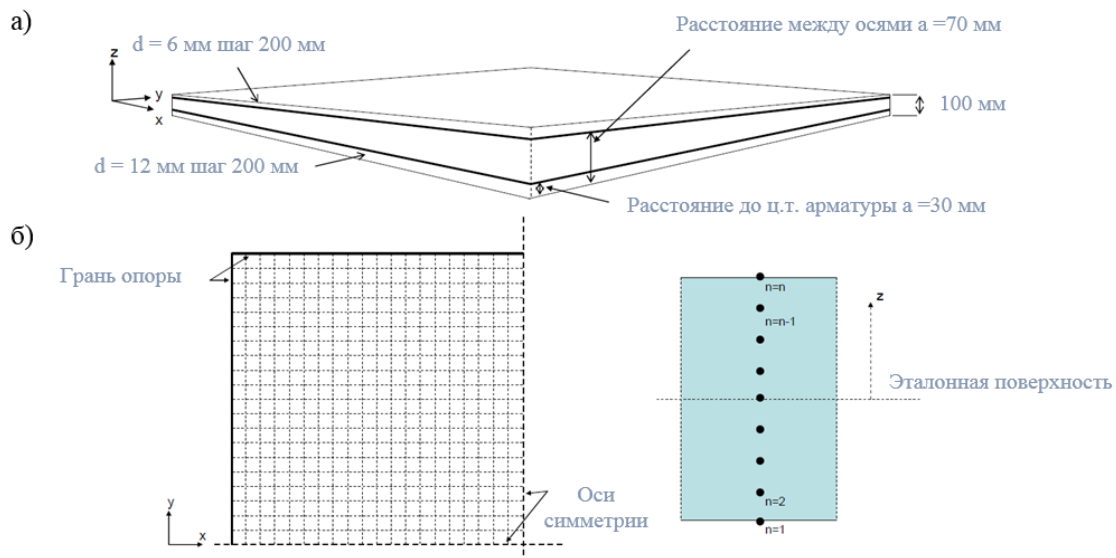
Геометрия железобетонной плиты: общий вид и армирование (а), конечно-элементная модель (б)
